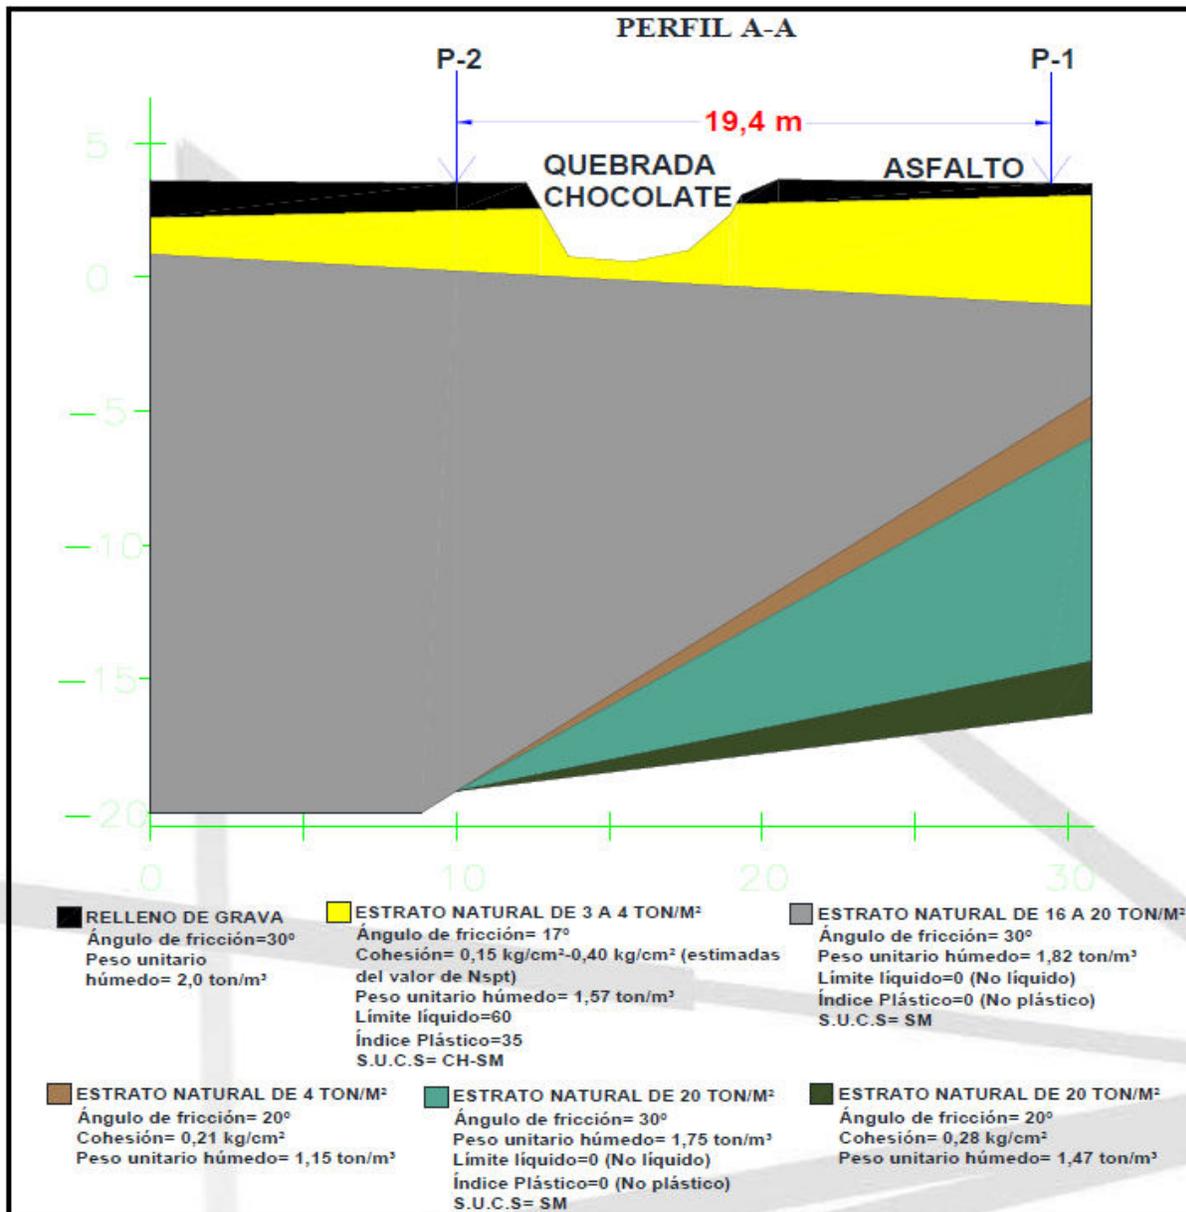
Perfil estratigráfico del sitio Alcantarilla Sur.
